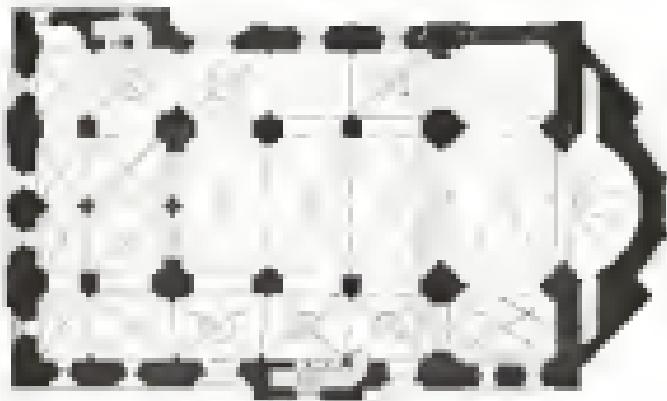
Borkenau. Grundriss der Festungskirche.
